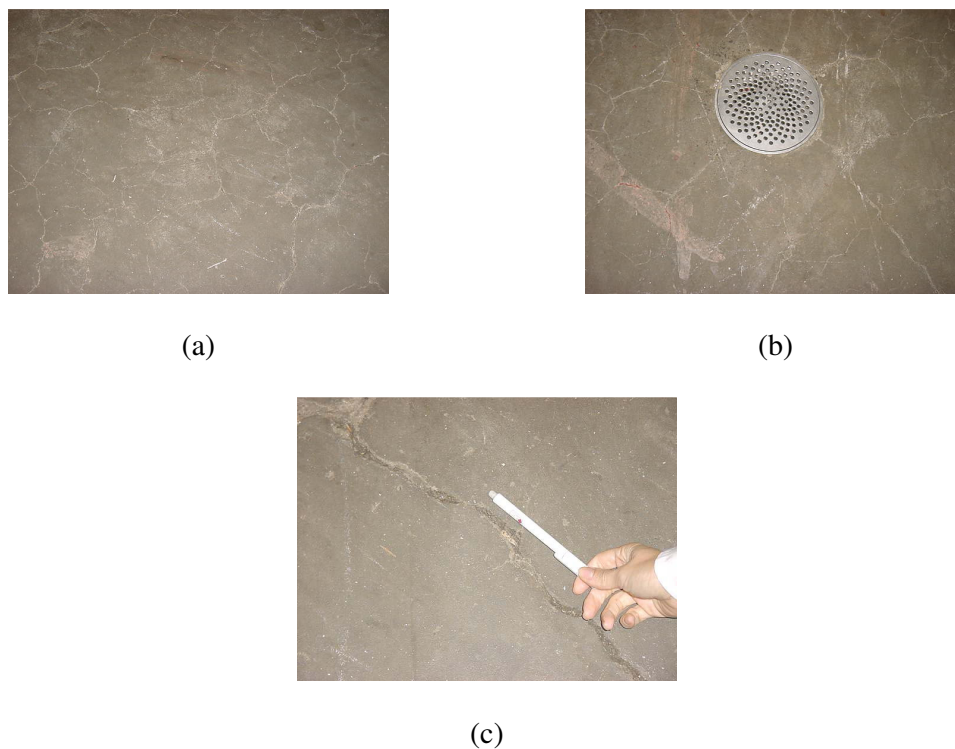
Detalhes do piso em um frigorífico com tempo de utilização de 18 meses. (a) Fissuração em rede atingindo toda a extensão do piso; (b) Estado mais intenso de deterioração nos caminhos preferenciais de água; presença de sangue nas fissuras colaborando para contaminação do ambiente; (c) Grandes fissuras já reparadas. Fonte: Lima e Liborio (2006)
